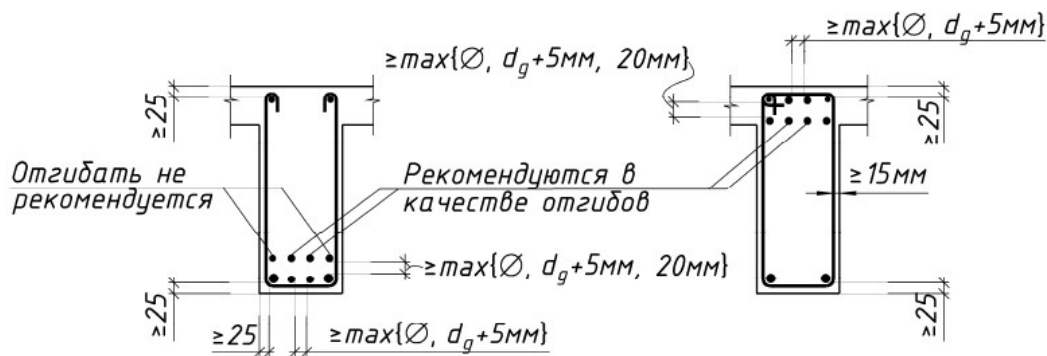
Расположение продольной арматуры в поперечном сечении балки
